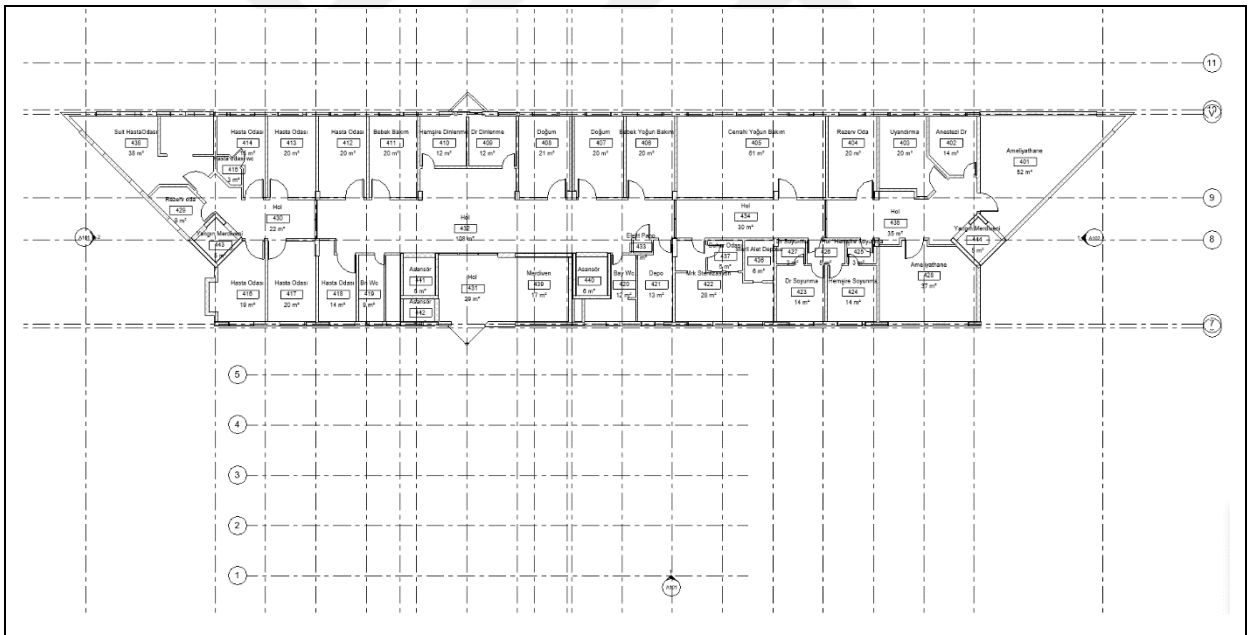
Özel hastane binası bodrum kat planı.
